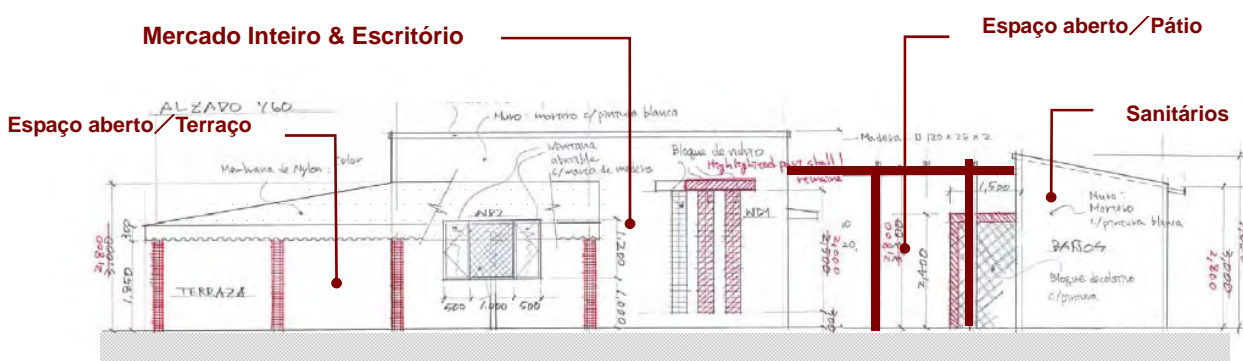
Edificação das Instalações (desenho da Equipa de Estudos)
